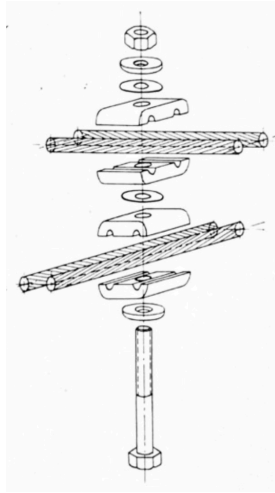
y 58 Vista y detalles de las uniones entre cables y cubierta, Parque Olímpico de Munich
